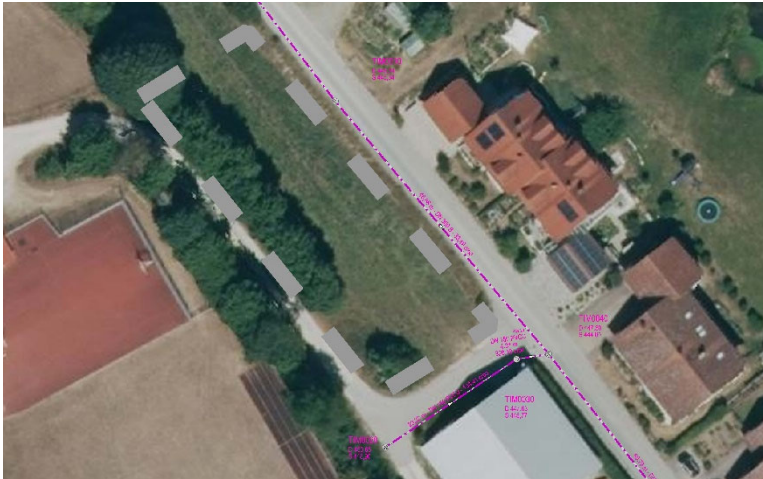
Planfläche mit Darstellung des Mischwasserkanals und der Erschließungsstraße unmaßstäblich
